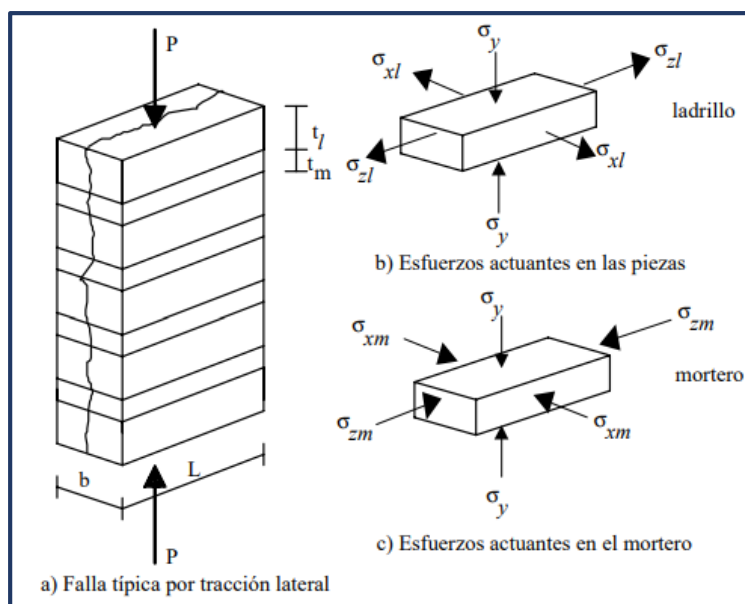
Mecánica típica de falla de la mampostería a la compresión
